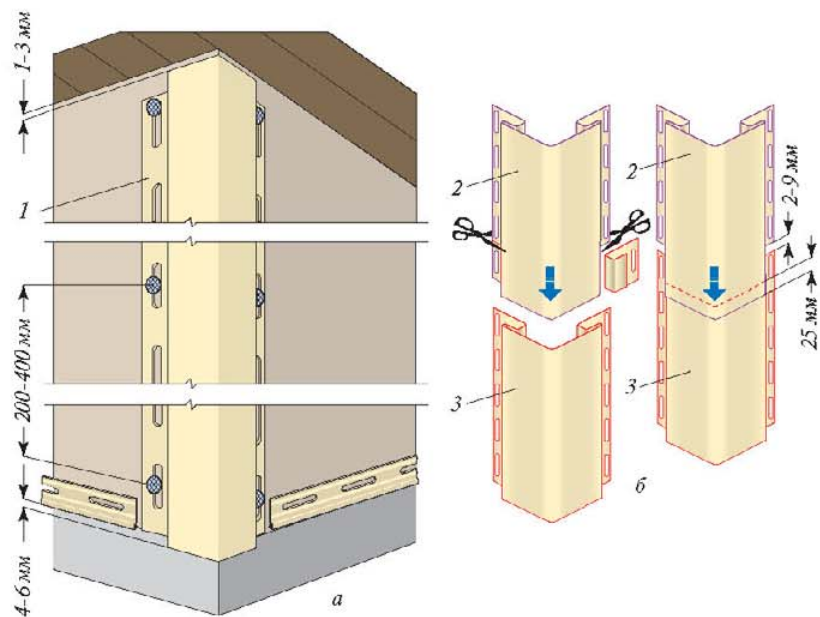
Монтаж наружного углового профиля: а — общий вид; б — стыкование угловых профилей внахлест; 1 — наружный угловой профиль; 2 — верхний профиль; 3 — нижний профиль
